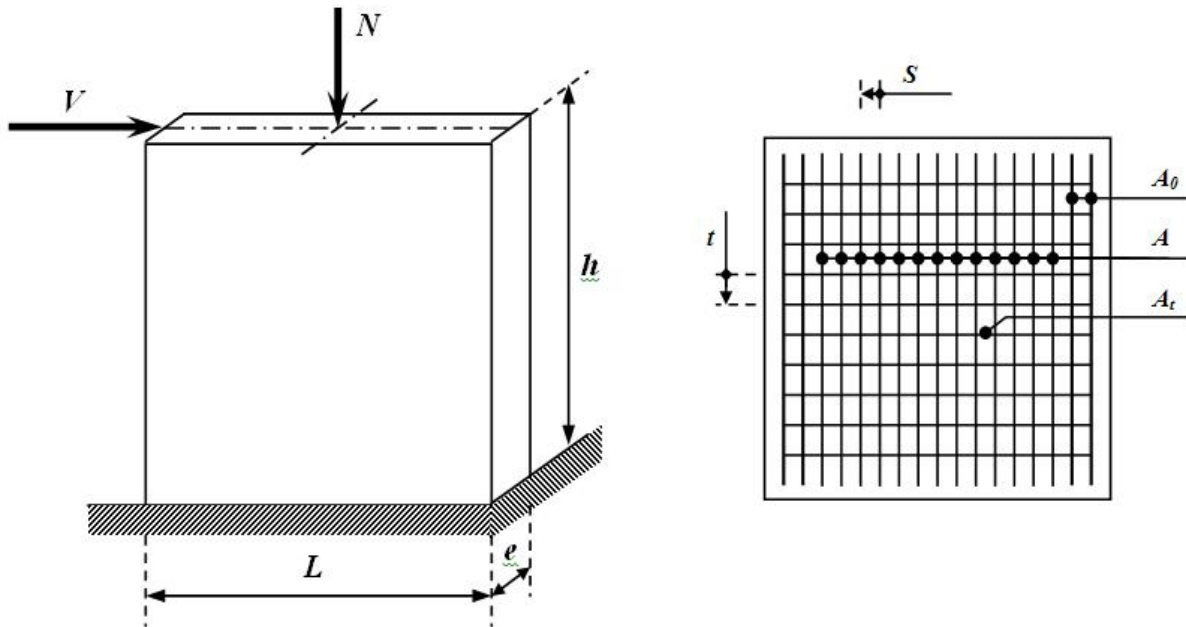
Schéma d'un voile plein et disposition du ferrailage
